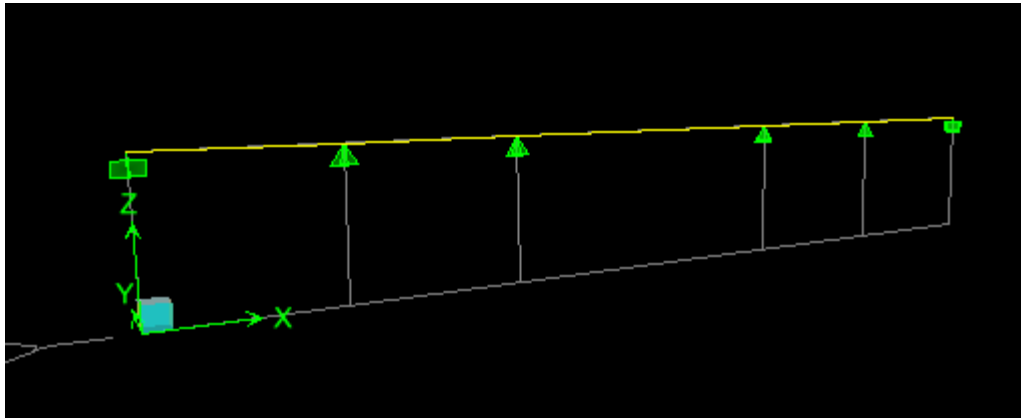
schéma statique des charges de la poutre de rigidité
